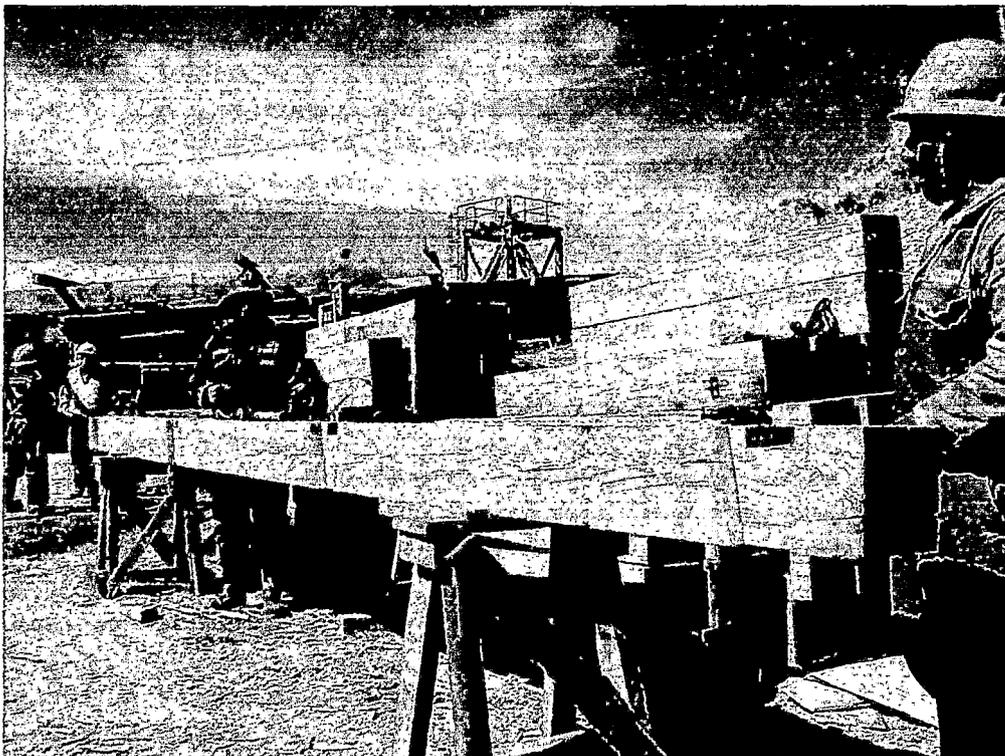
EN ESTE CASO SE OBSERVA EL DETALLE EN LAS GUIAS DE MADERA.
